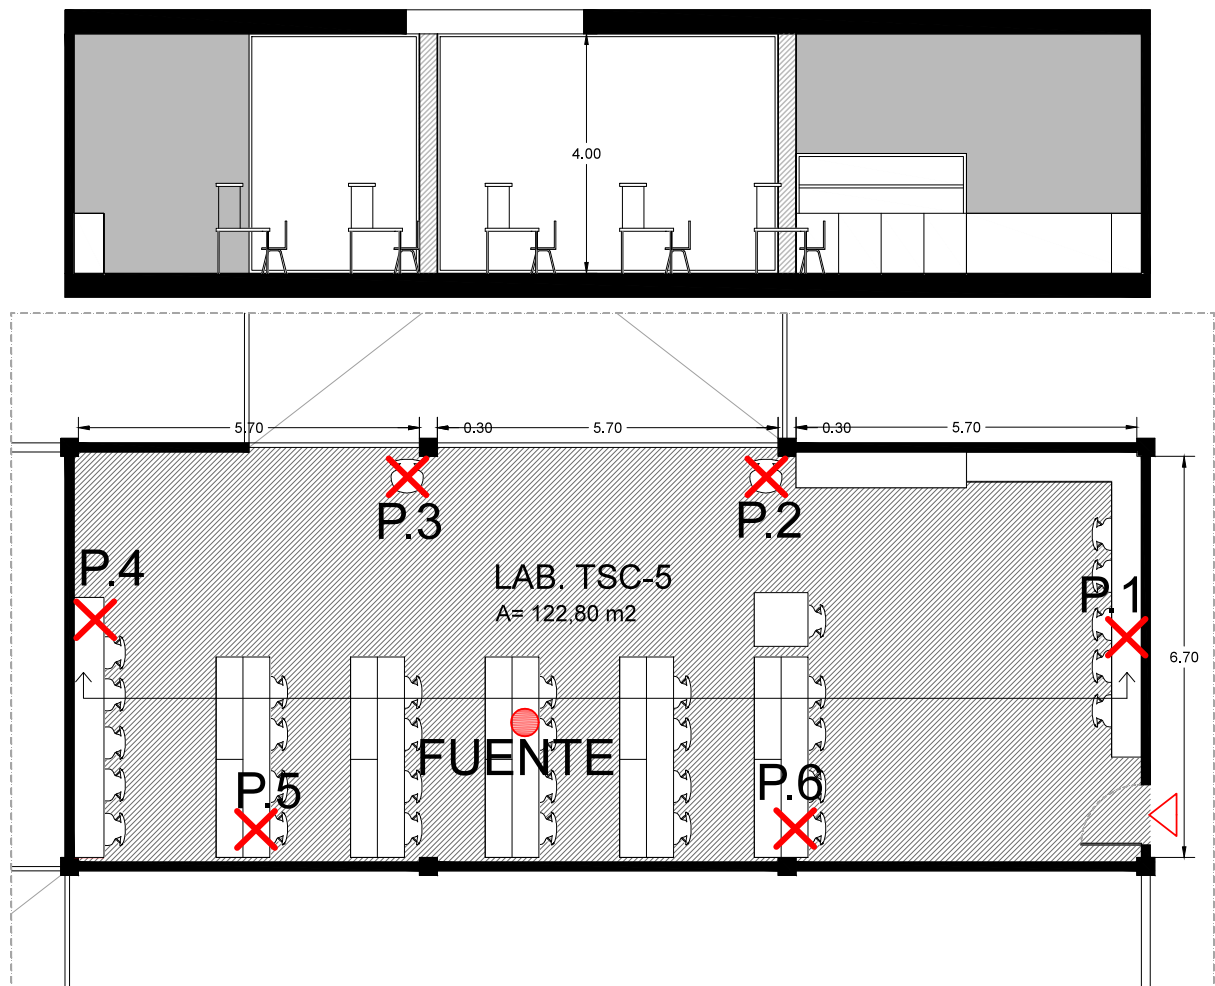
Planta y alzado del laboratorio TSC-5 de la ETSIT.
